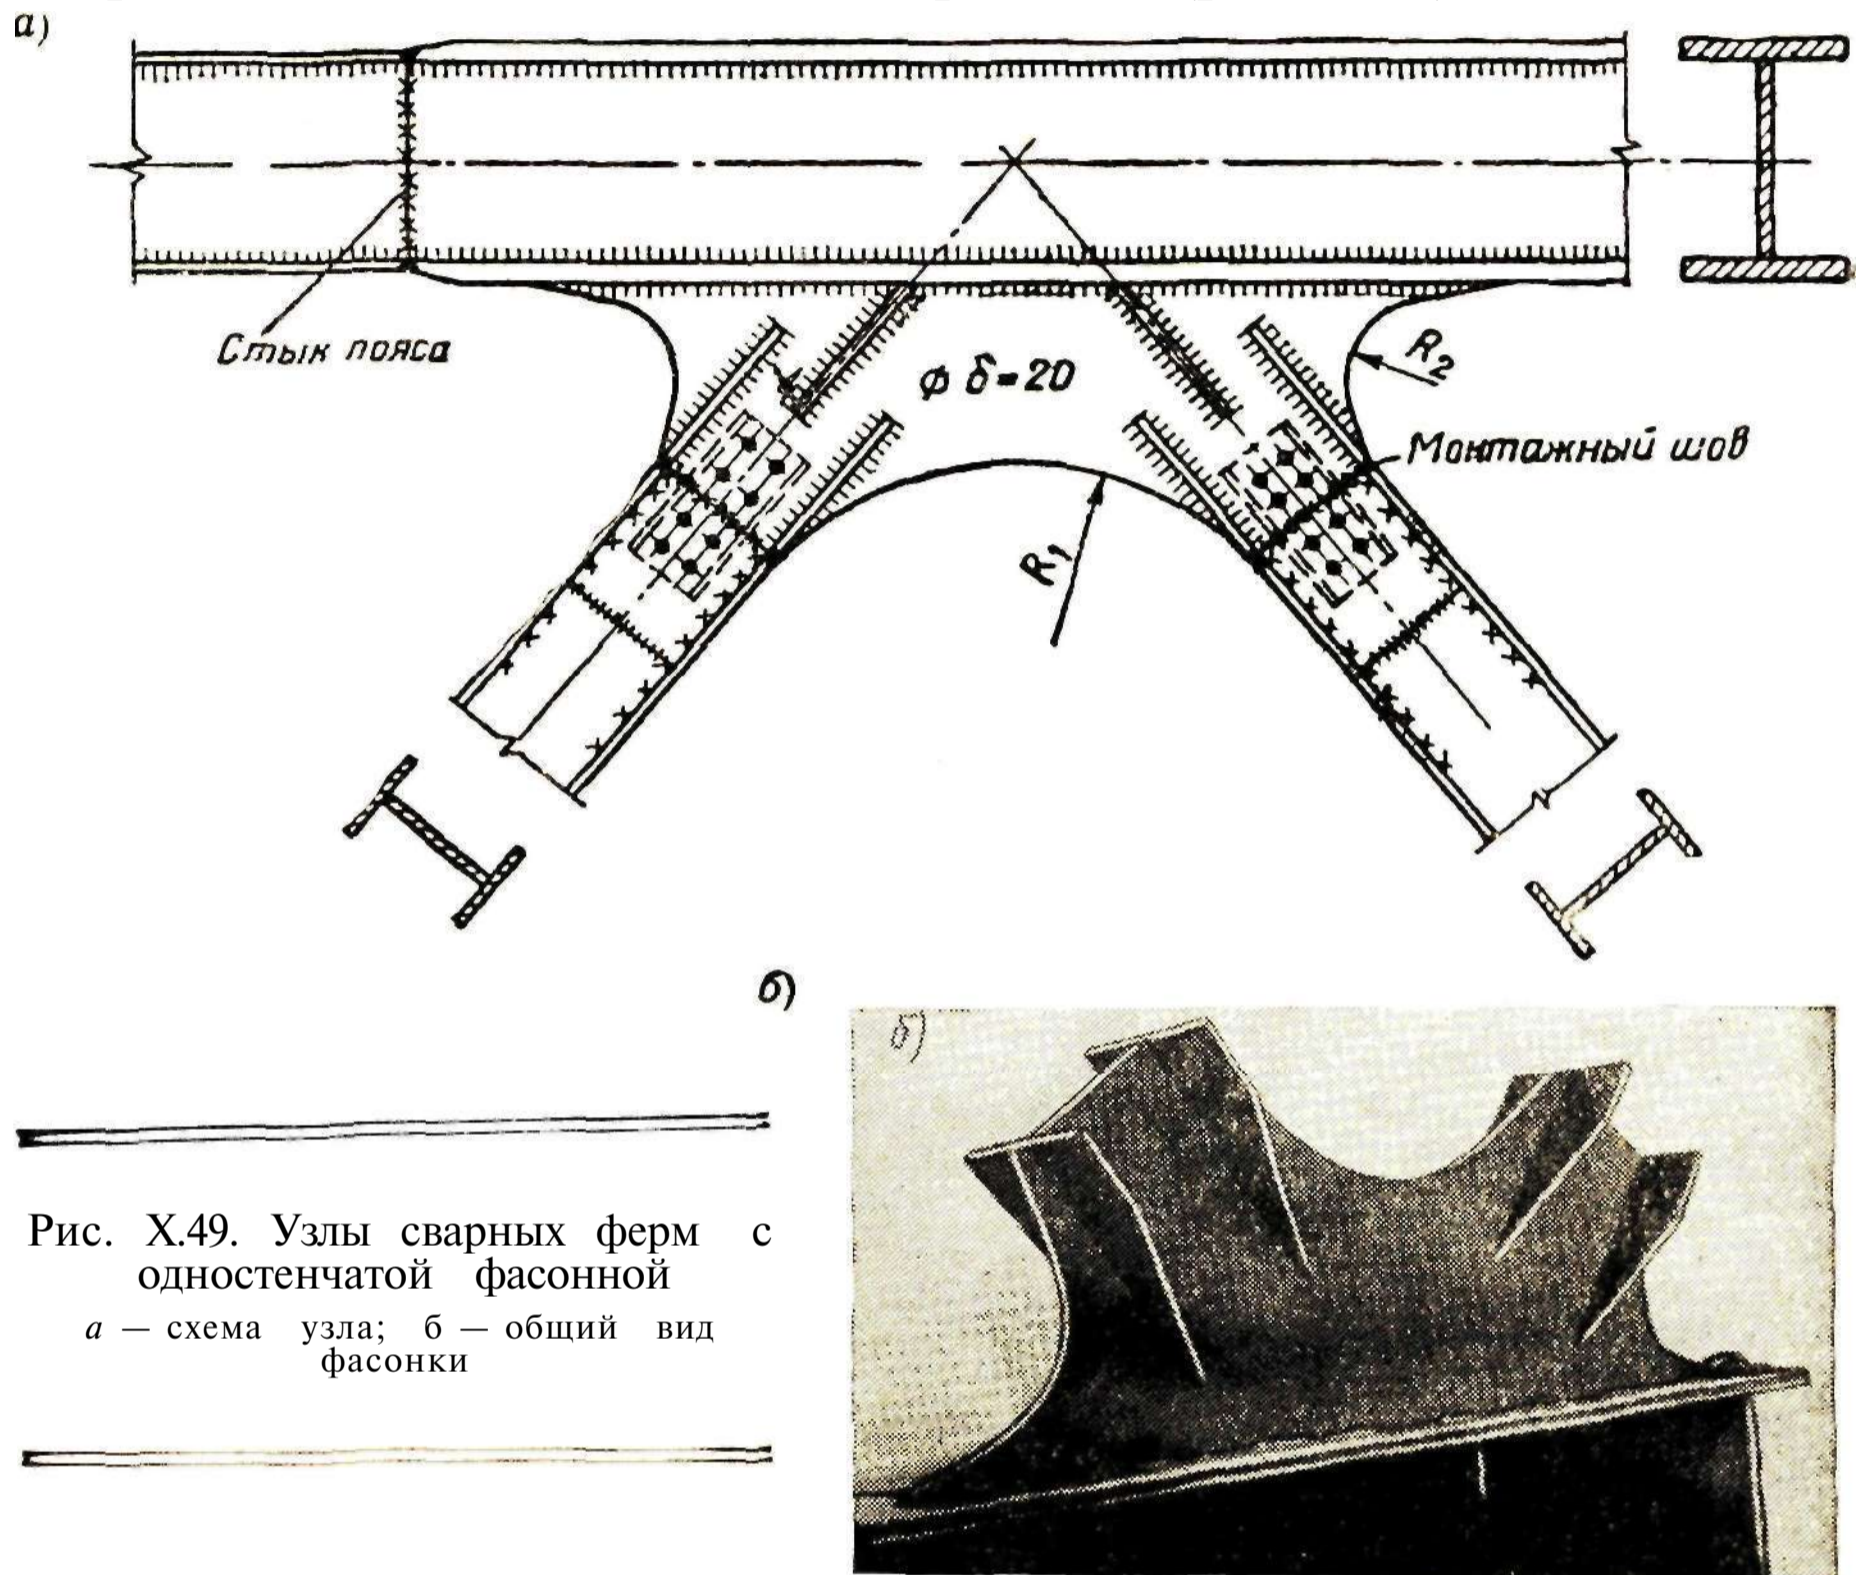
Узлы сварных ферм с одностенчатой фасонкой
